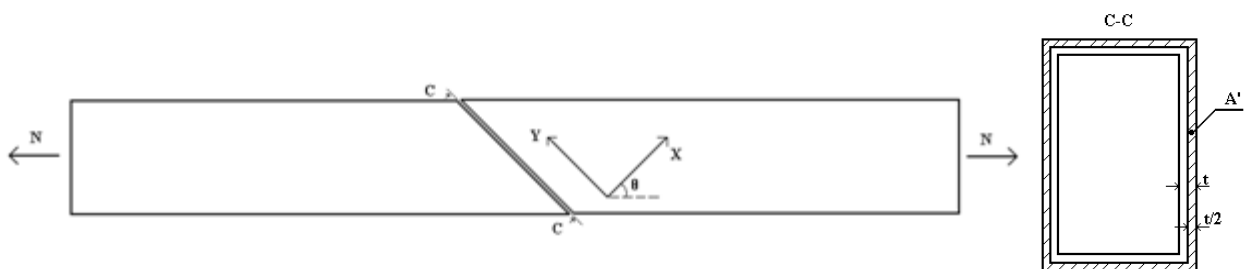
Representação em corte da zona de ligação por soldadura, de um corte oblíquo
